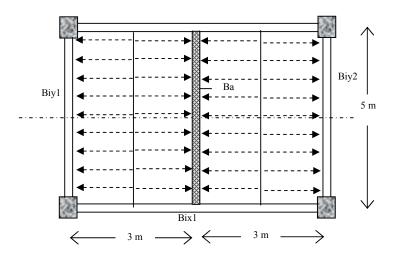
Denah Type Balok Pracetak Saat Pemasangan
